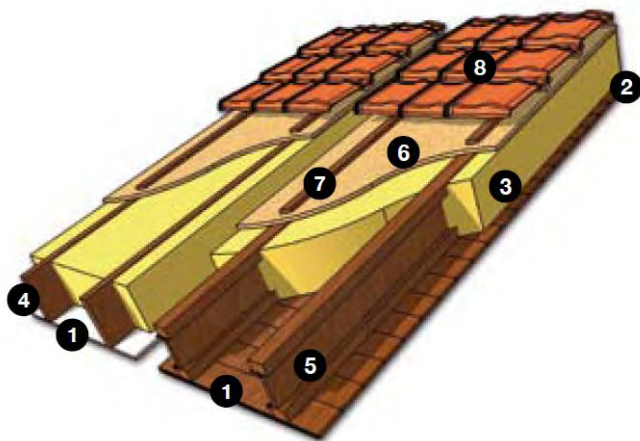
Esquema de hormigón de cáñamo en aislamiento de techumbre, sistema porta cabrios
